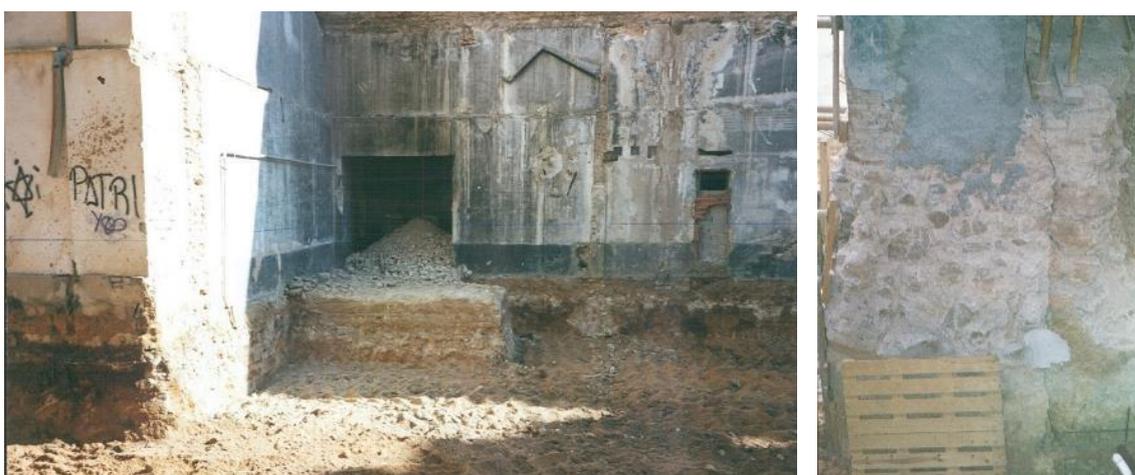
Cimentación al descubierto por excavaciones hechas durante las obras de rehabilitación.
